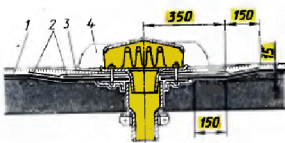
Водоприемные воронки в покрытиях с железобетонными плитами при неэксплуатируемой крыше:
